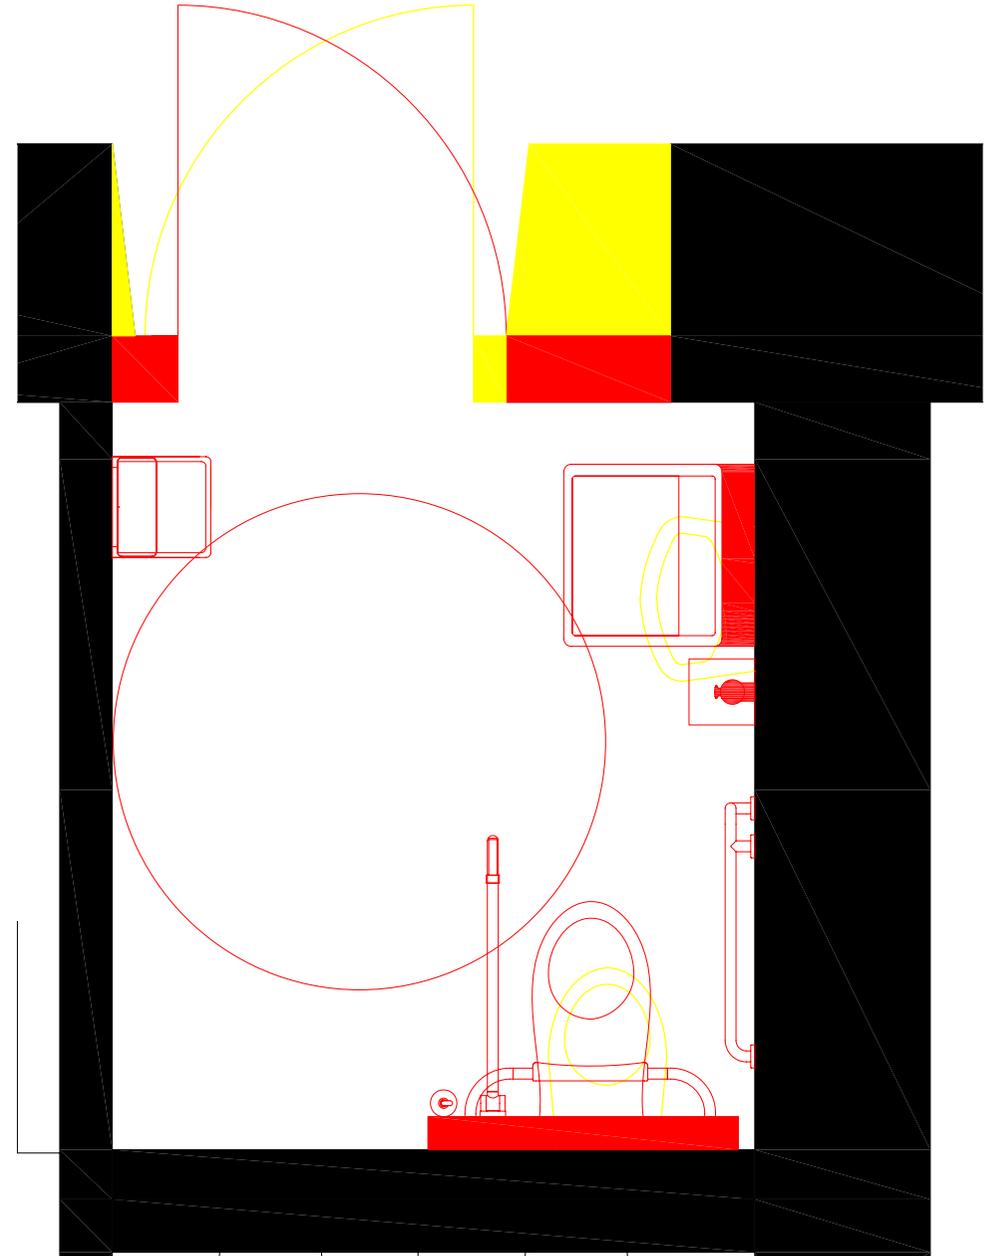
Abbruch und Neubau zur Herstellung eines barrierefreien WC-Raumes im Erdgeschoss
